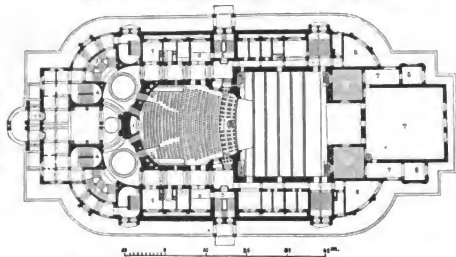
Grundriss zum Proj. Motto „Doch die Elemente haben etc.“
